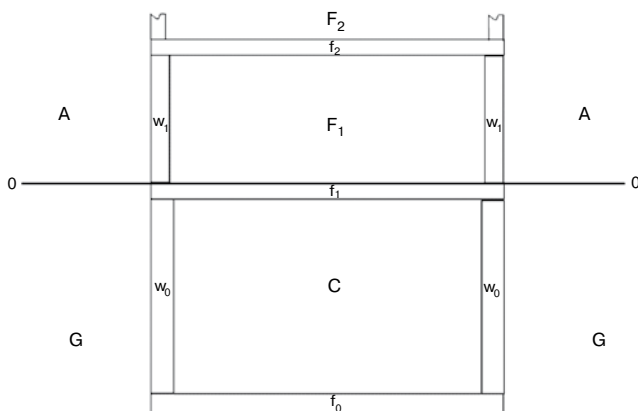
Вертикальный разрез здания с подвалом: А – атмосфера; G – грунт; С – подвал; F₁, F₂ – первый, второй этажи; w₀, w₁ – стены; f₀, f₁, f₂ – перекрытия
